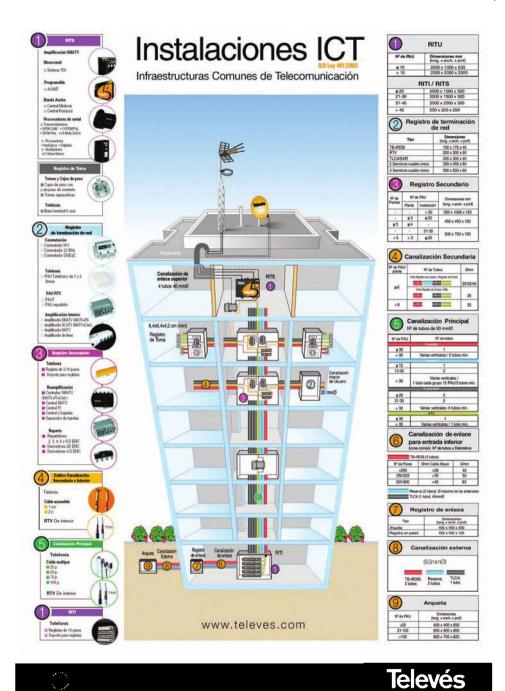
Estructura de la ICT en un edificio. (Cortesía de Televés.)
